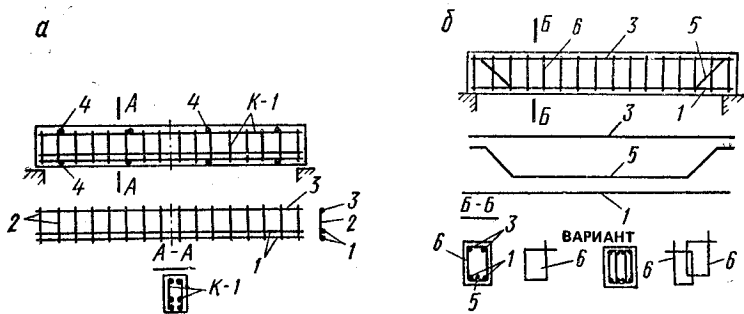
Схемы армирования балок сварными каркасами К-1 (а) и вязаной арматурой (б)
